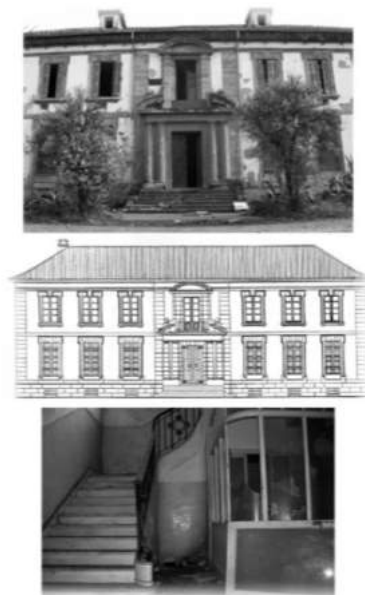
Vista parcial de la fachada de las oficinas generales, alzado planimétrico de la misma (SARMIENTO 1992, 94, fig. 9) e interior (portería), antes de que arrancasen de cuajo los mármoles de la escalera y el hierro forjado de su barandilla
